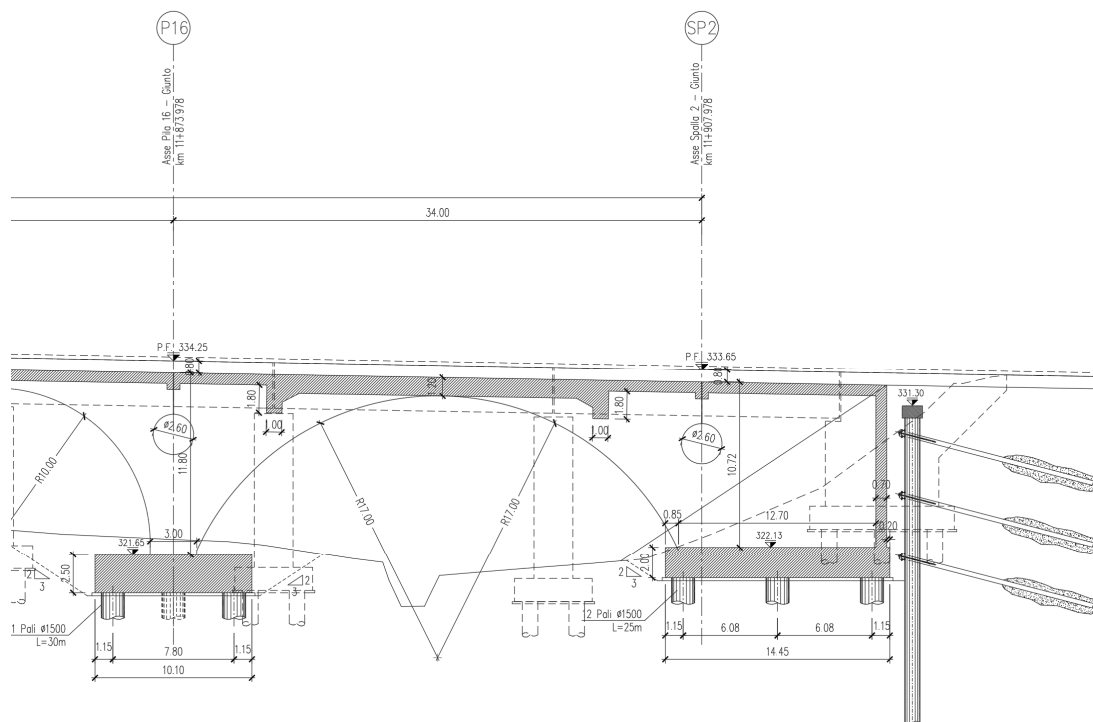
Sezione longitudinale cassone spalla 2 e ultimo arco
